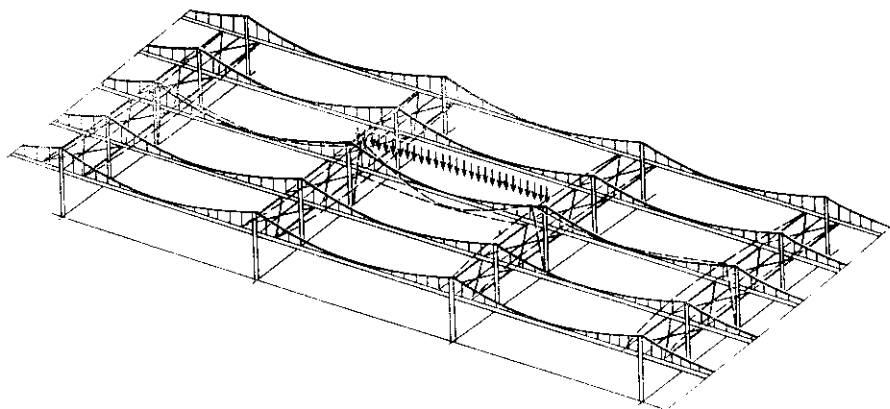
Распределение местных полосовых нагрузок с помощью продольных горизонтальных связей в схемах с неразрезными колоннами
